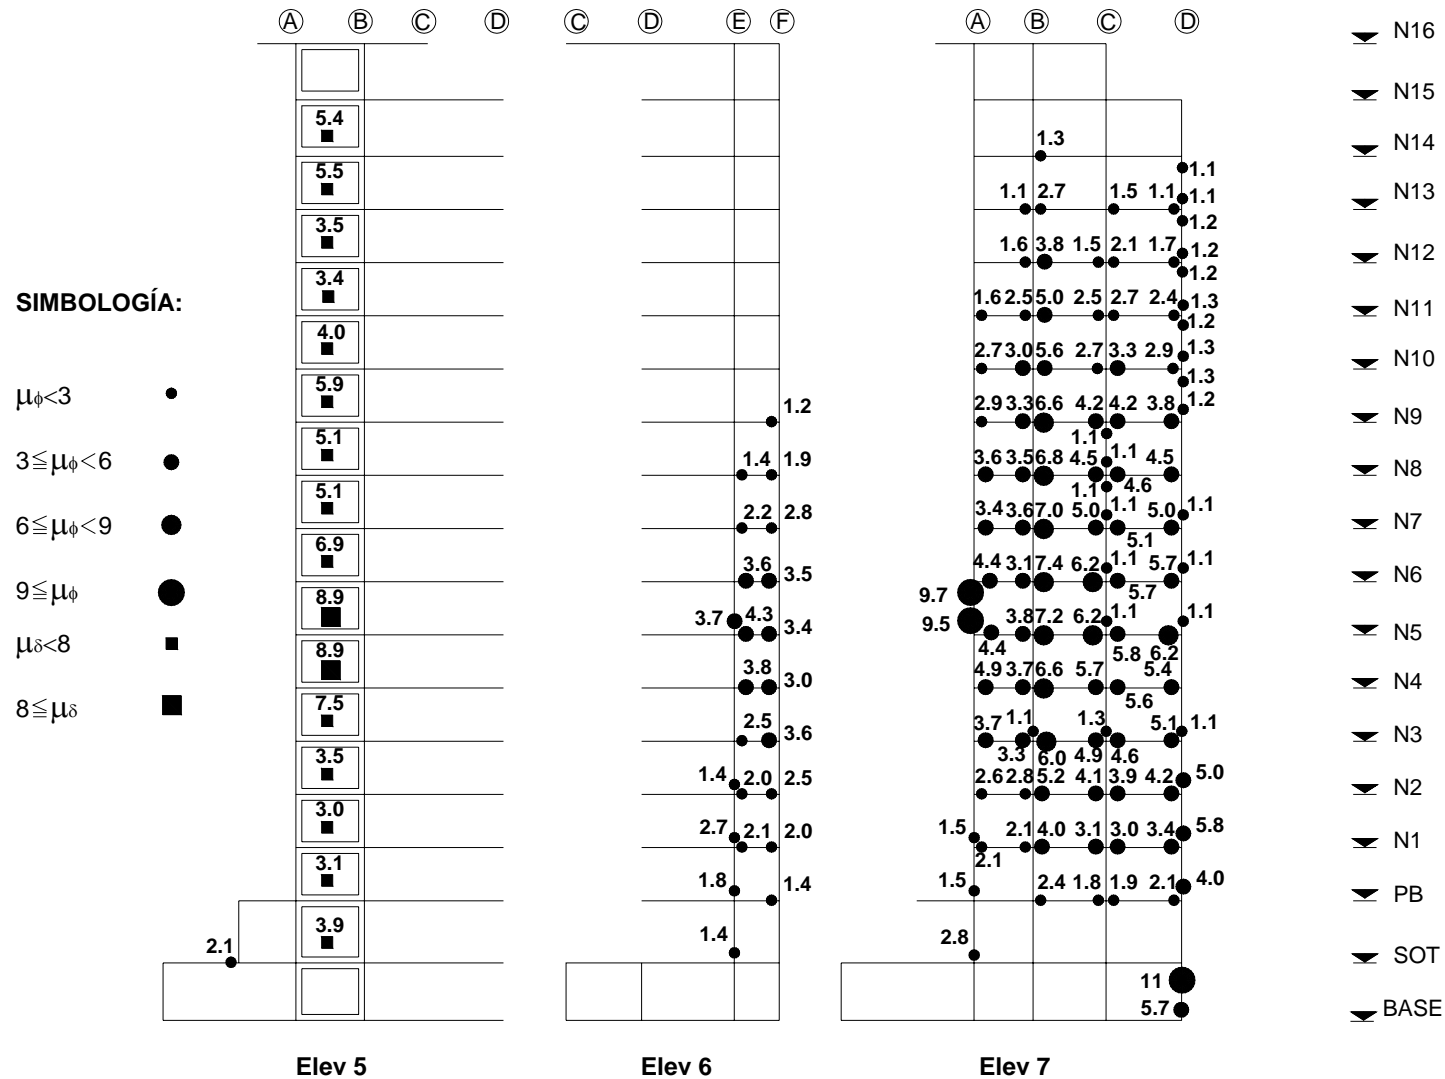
Ductilidades locales máximas de vigas, columnas y muros de concreto reforzado, en las elevaciones 5, 6 y 7, para la SIM64
